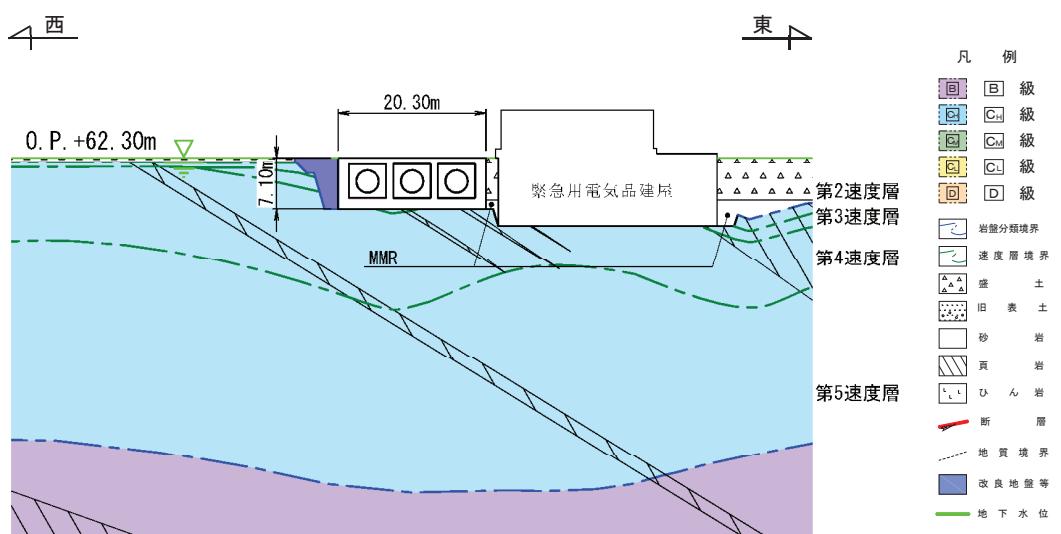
ガスタービン発電設備軽油タンク室地質断面図 (A-A)
